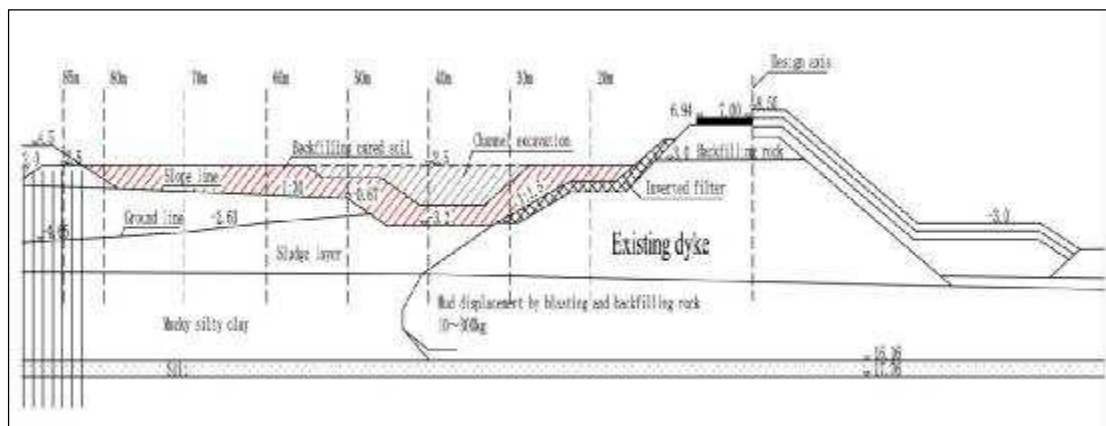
Étape 2: excavation du canal sur la plate-forme
